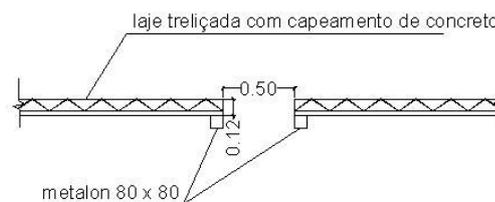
Detalhe do sistema de apoio da abertura da laje superior. Details of the support of the upper slab opening.
